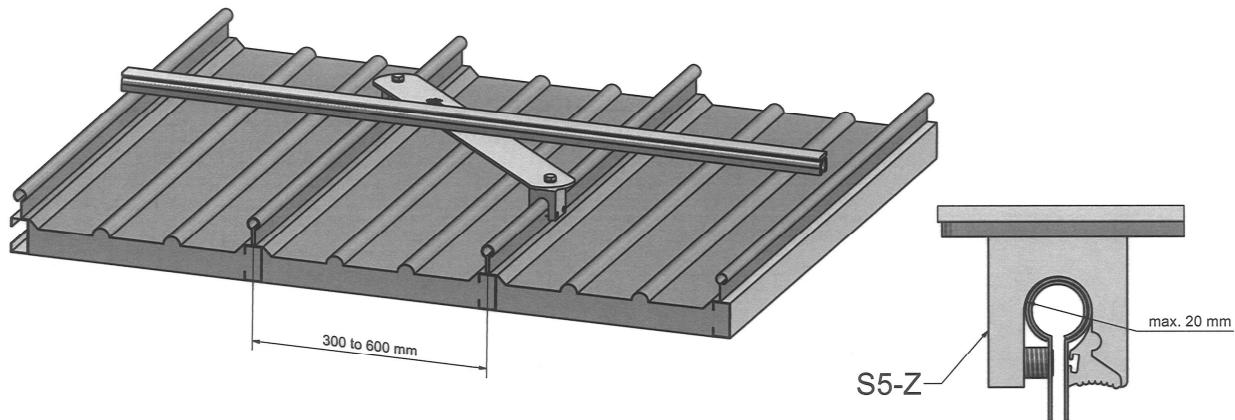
LDV024/LDV014 Ensemble de fixation sur panneaux Corus KALZIP 50/333
